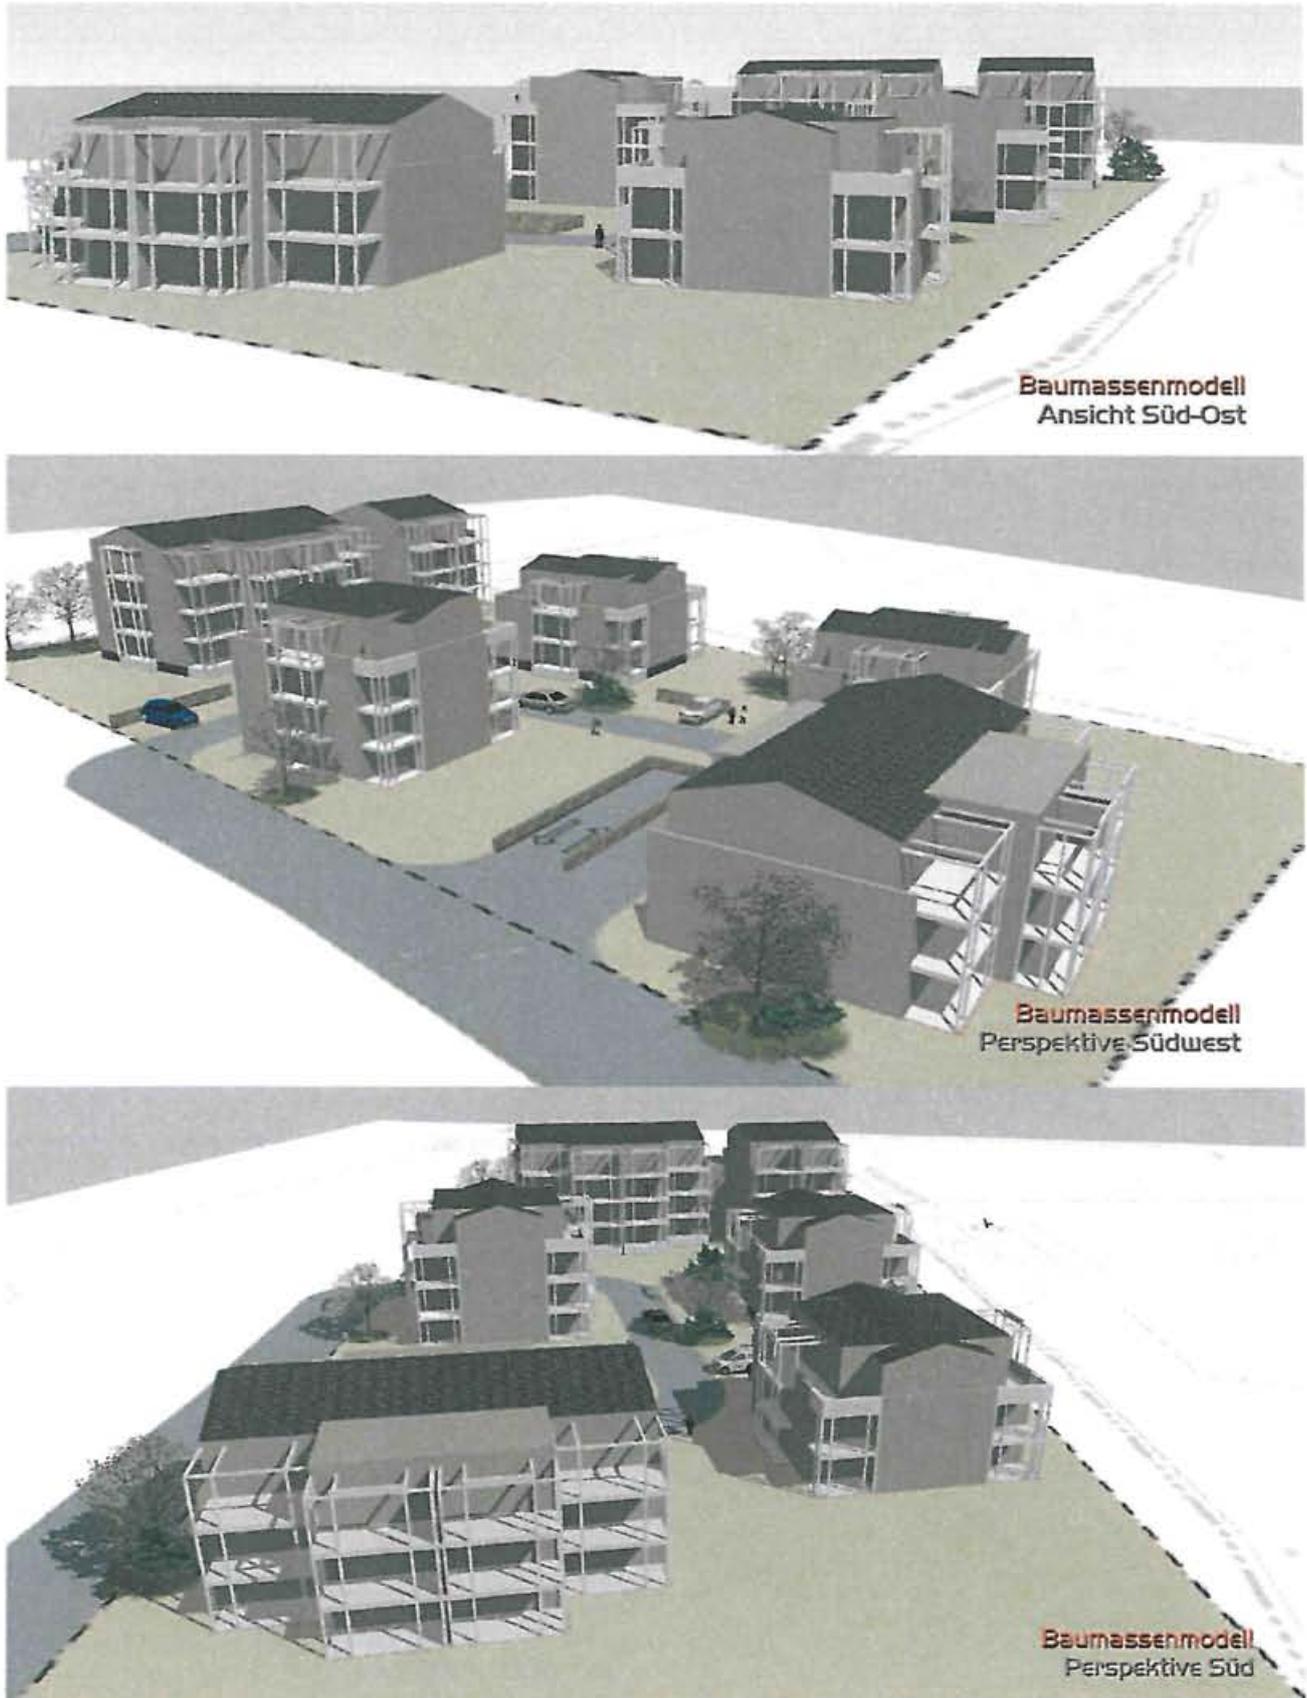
Baumassenmodell Stand 08/2012, Planungsbüro bauART (ohne Maßstab)
